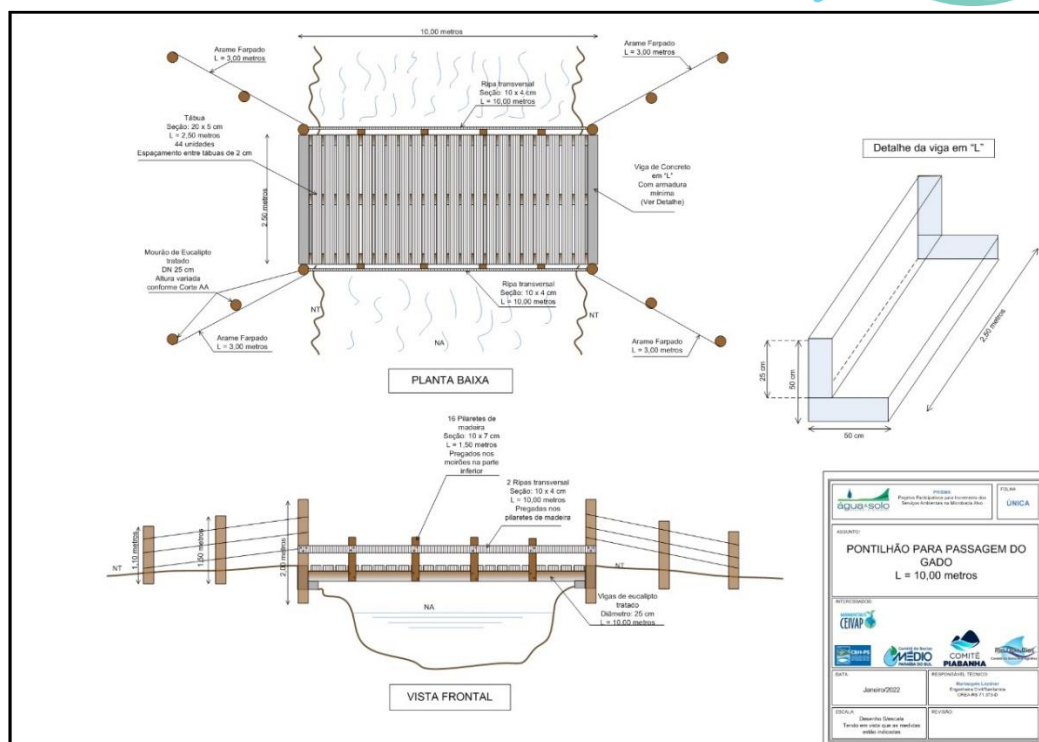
Planta baixa e vista frontal do pontilhão de 10X2,5m
